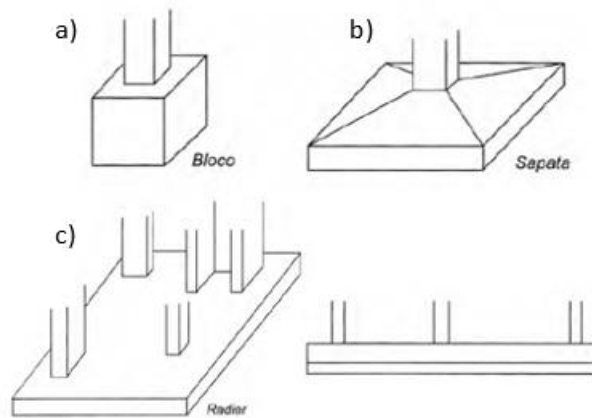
Tipos de fundações superficiais: (a) Bloco, (b) Sapata isolada e (c) Radier
